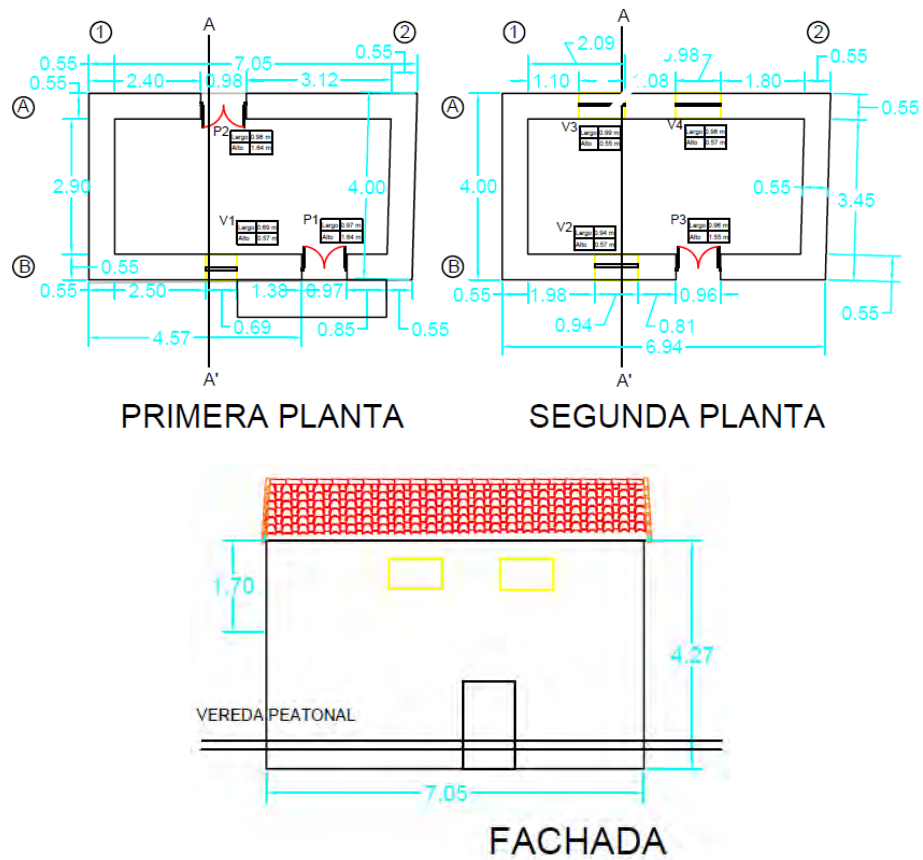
Plano en planta y elevación de la vivienda N° 15, ubicada en la zona B. Fuente: Elaboración propia, 2019.
